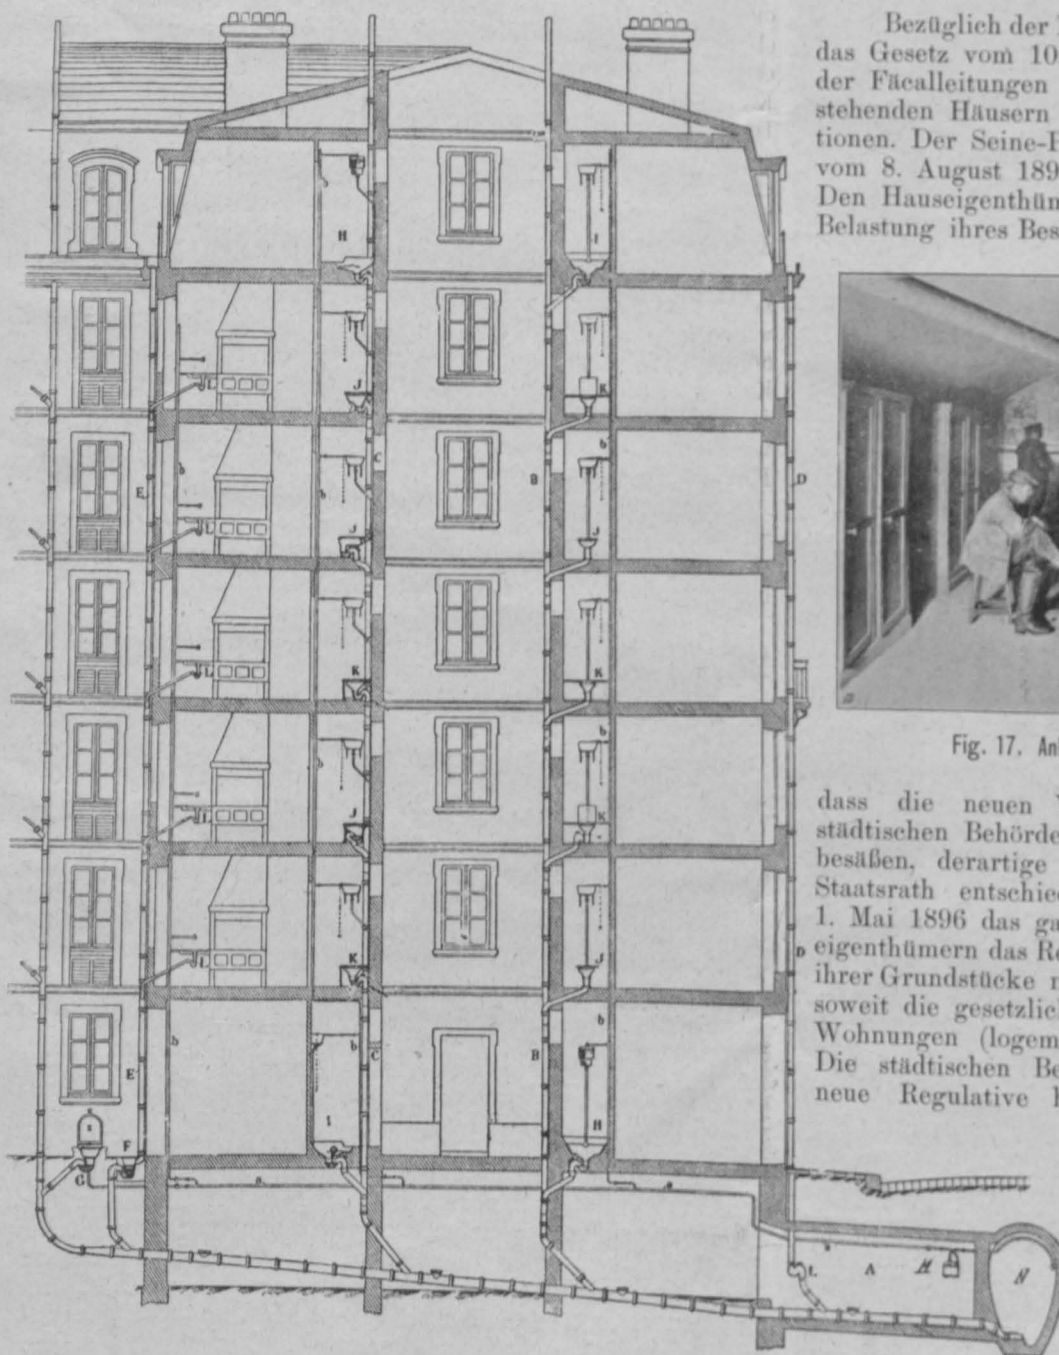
Entwässerungsanlage eines neuen Pariser Hauses.
